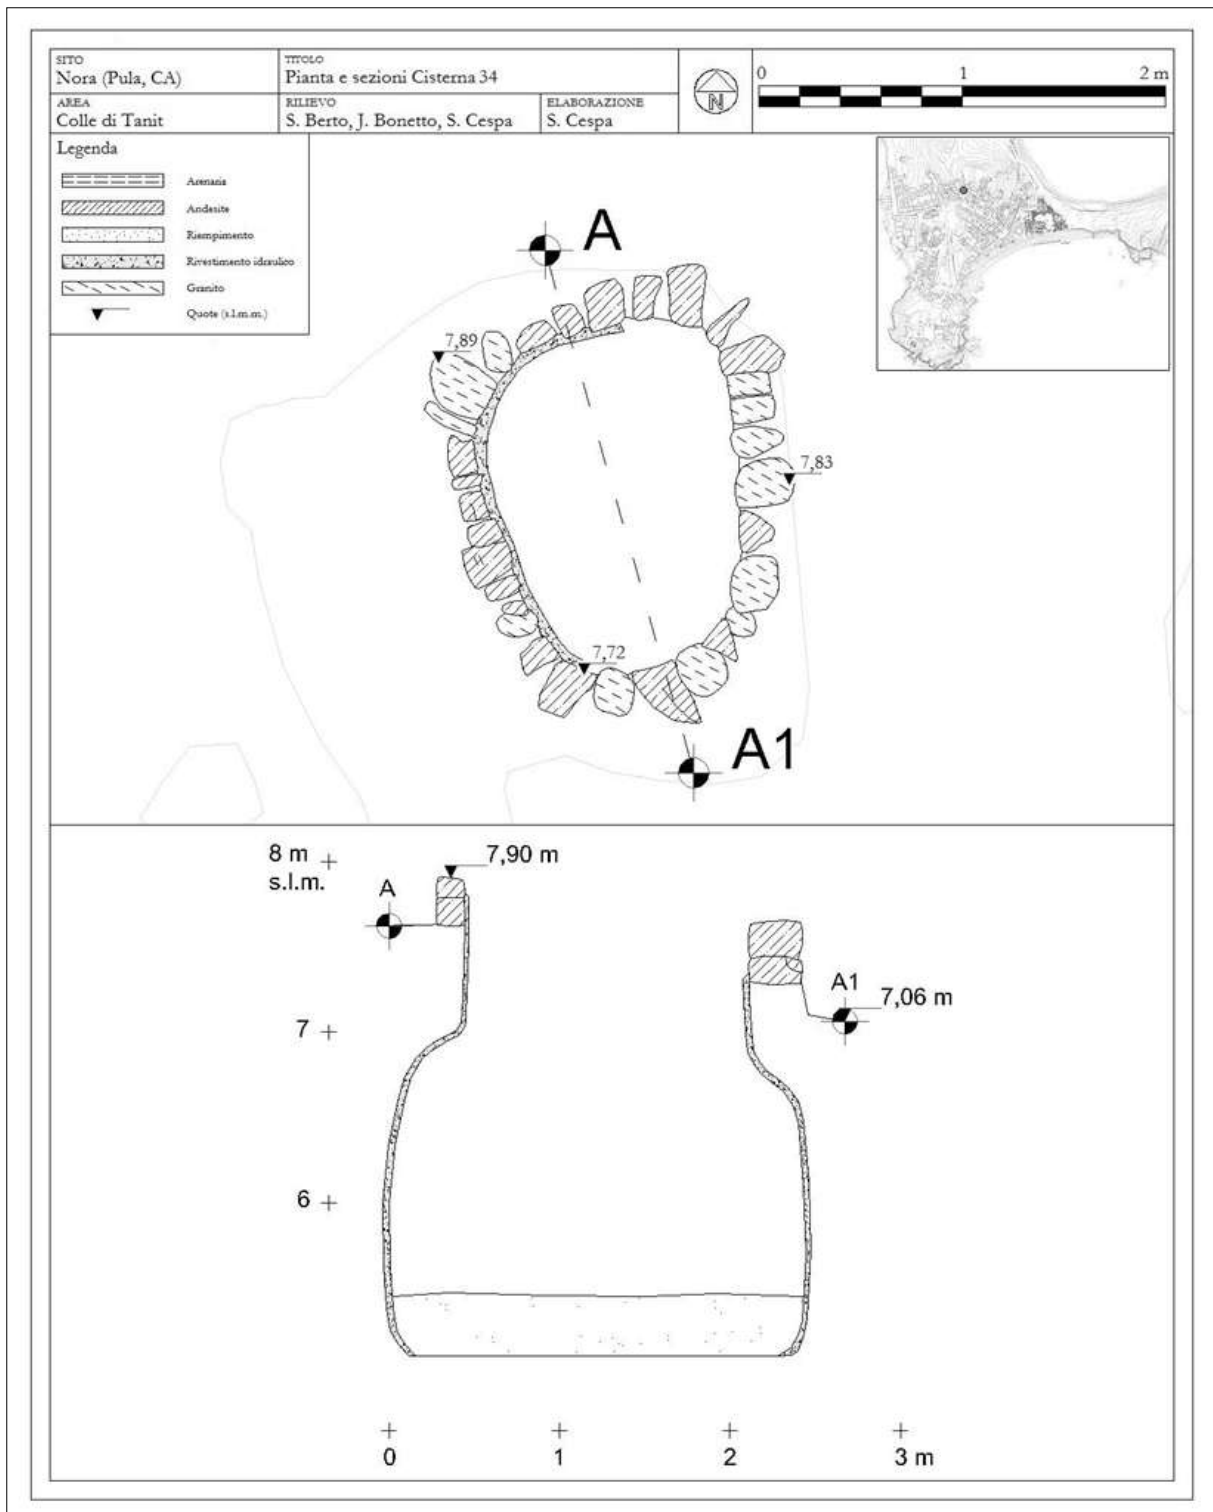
Pianta e sezioni della cisterna 34 (elaborazione dell'autore).
